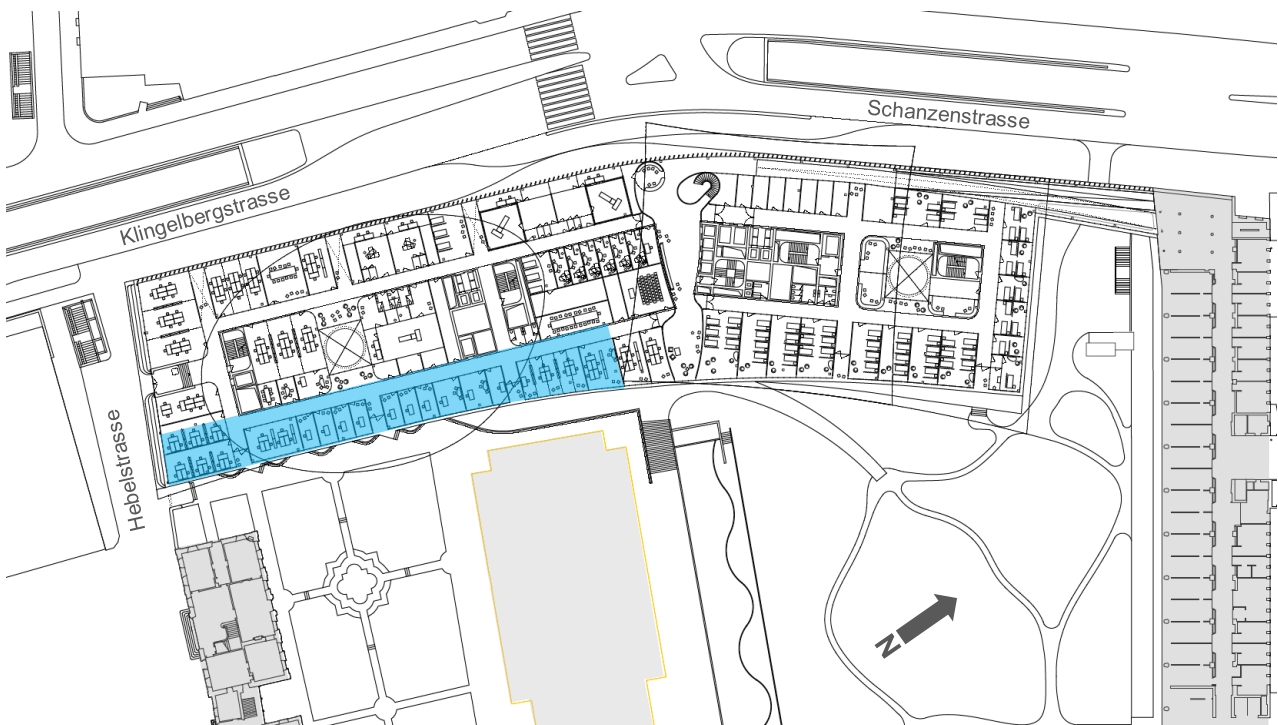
Grundriss 1. Obergeschoss: Stand Projektwettbewerb (blaue Fläche: Flächenverlust). Sofern die bestehende Baumreihe im denkmalgeschützten Bereich erhalten werden soll, muss der Baukörper in diesem Bereich um eine Gebäudeachse reduziert werden. Dies bedeutet, dass der Sockelbau nicht mehr als Dreispänner mit zwei Verbindungsgängen realisiert werden kann, was erheblichen negativen Einfluss auf die Flächenverfügbarkeit und Funktionalität hat. Die für diesen Bereich angedachte Nutzung wäre nicht mehr möglich.
